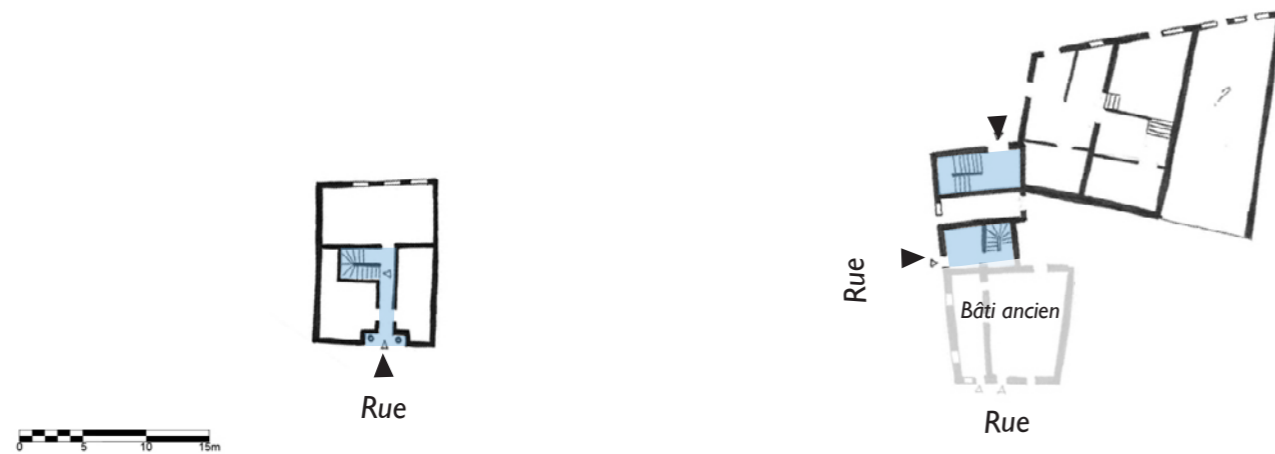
Plans rez-de-chaussée des immeubles collectifs
